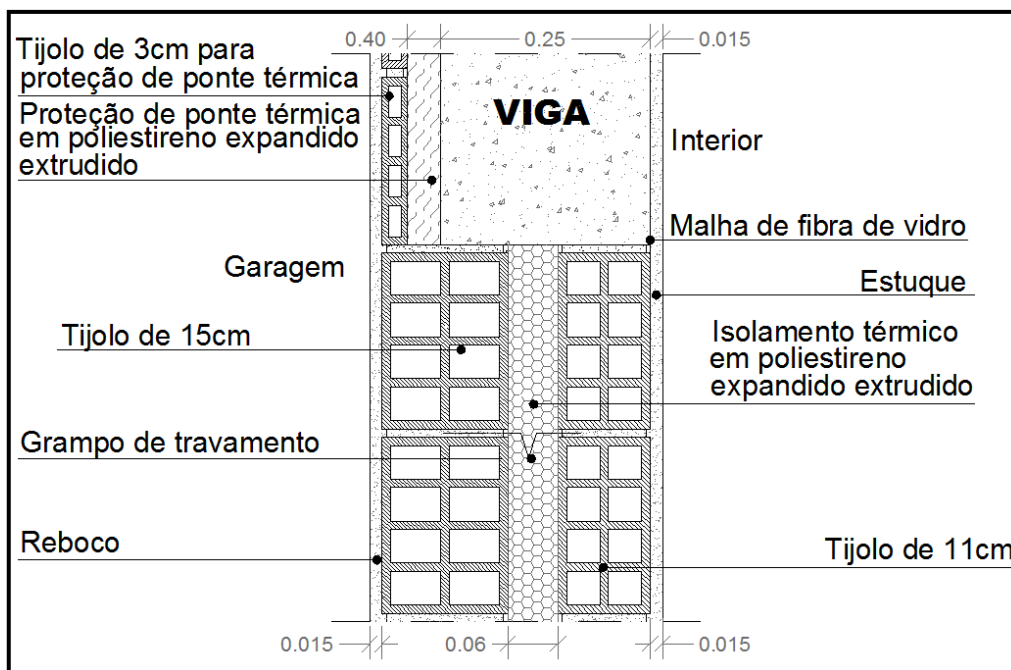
Pormenor da parede e viga de separação entre espaços úteis e não úteis, em corte (Pi1 e PTPi1)
